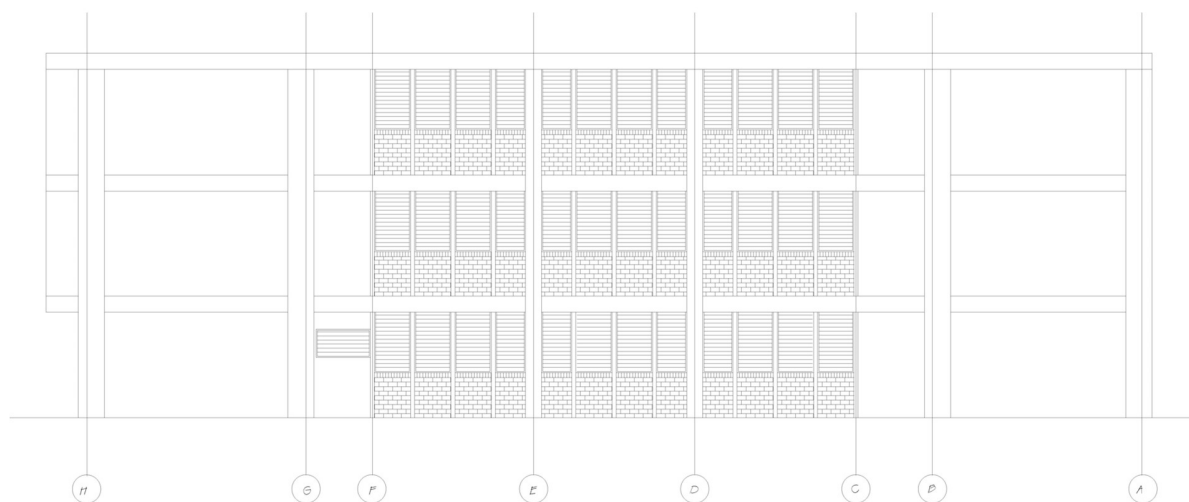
Planos Arquitectónicos – Fachada Lateral Derecha.
